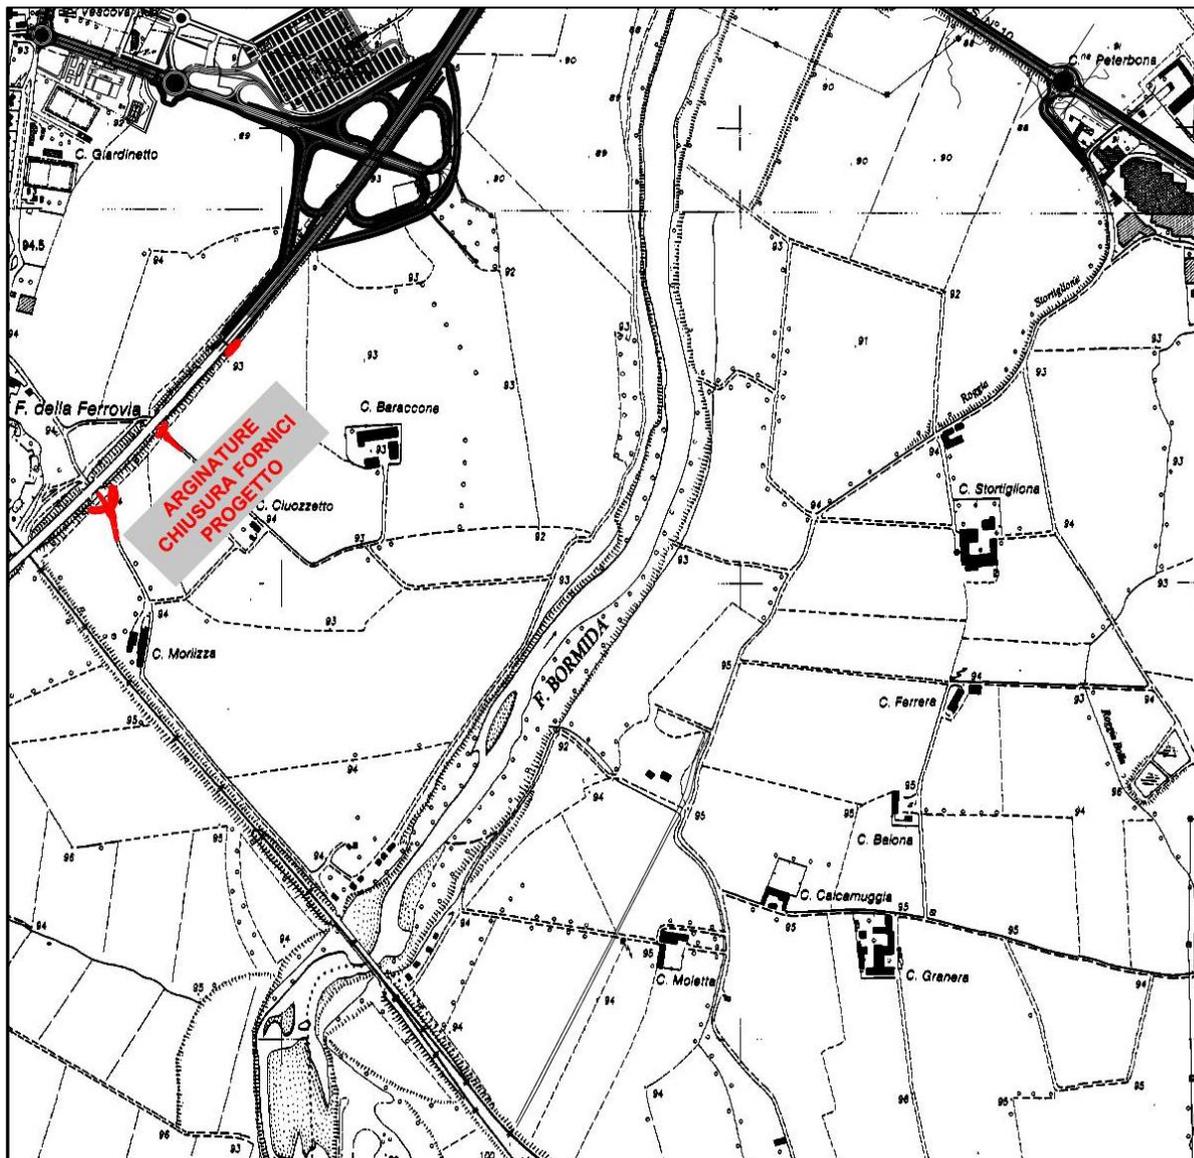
Planimetria ubicazione interventi di adeguamento opere di difesa idraulica
